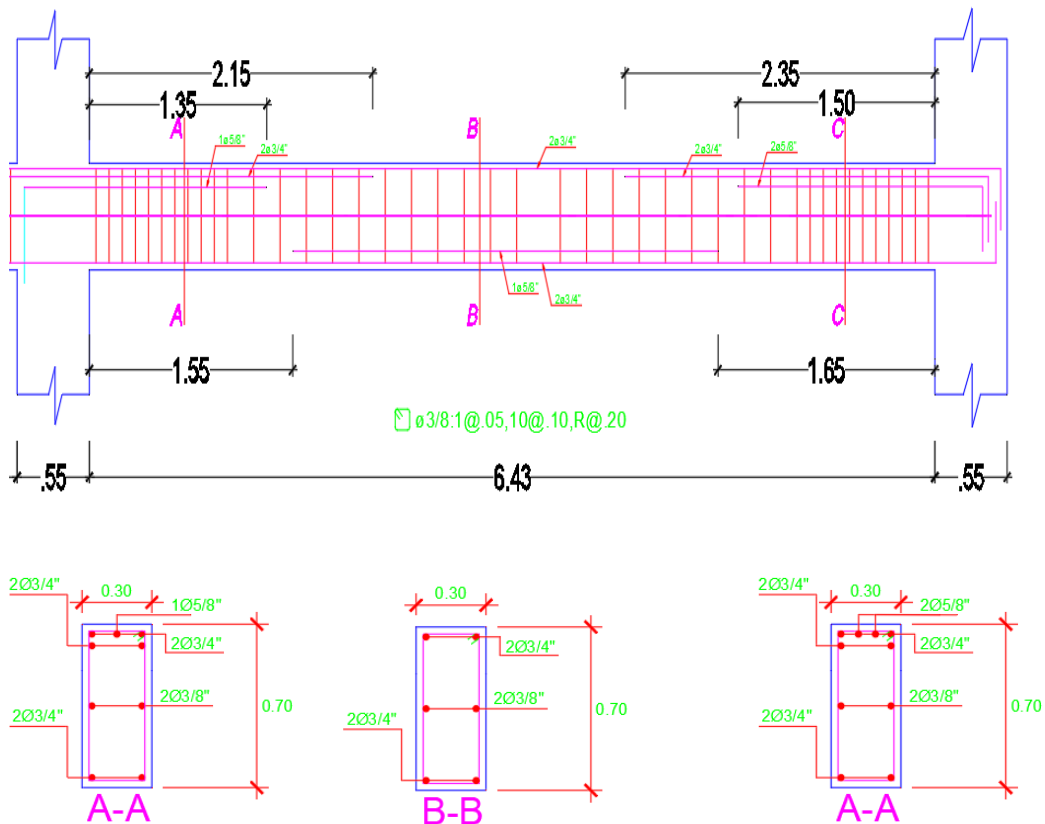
Detallado final de la viga del eje 2, entre eje E y F
